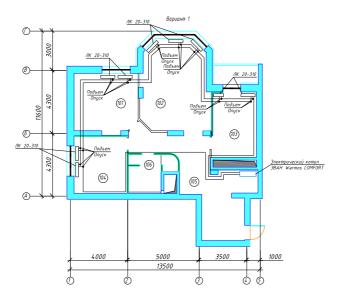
План трехкомнатной квартиры с угловыми помещениями с горизонтальной системой отопления с радиаторами (Вариант № 1)
